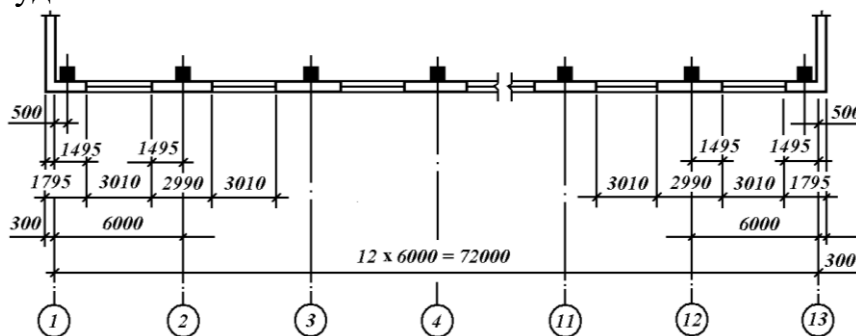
Приклад нанесення розмірів на будівельних кресленнях
